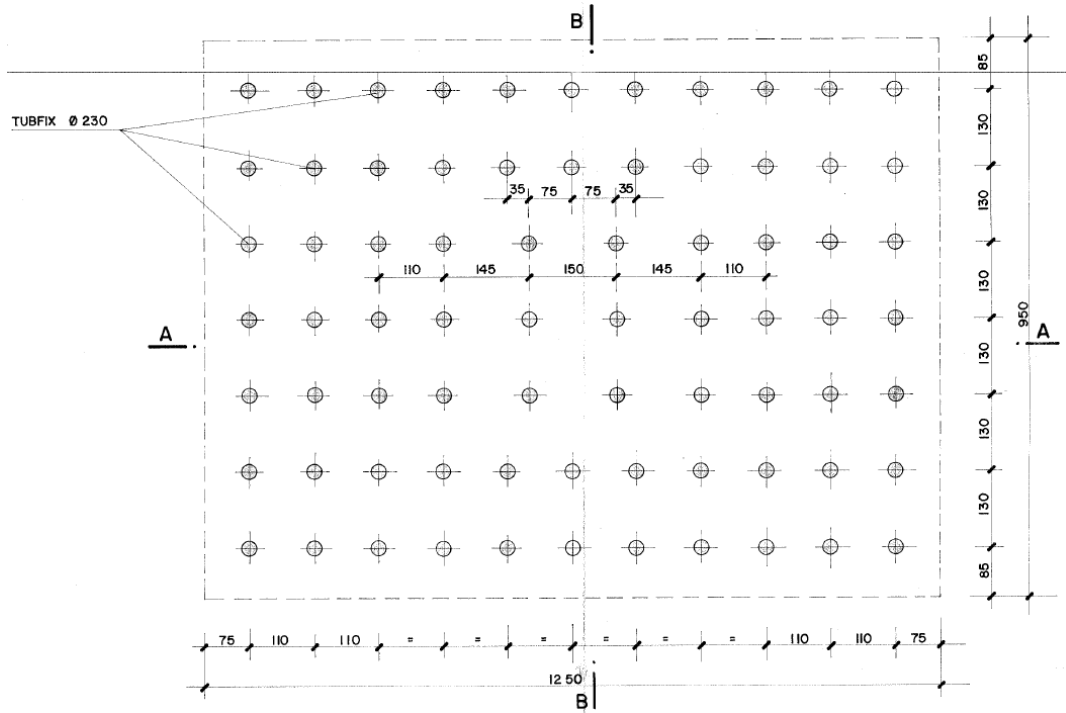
Pianta pile P17÷P20 su fondazione diretta con n°74 micropali
